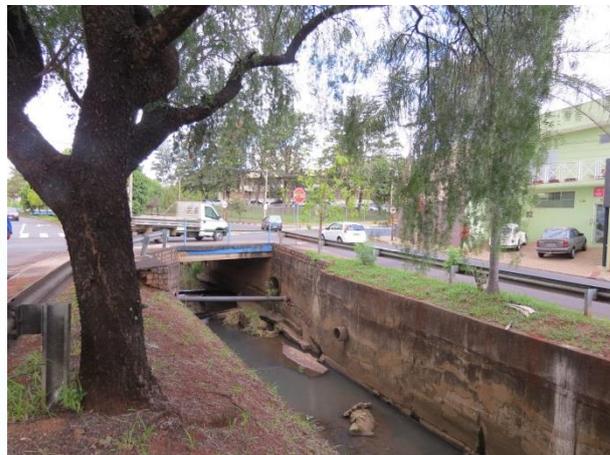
Vista de travessia do córrego Gregório, em trecho afetado por inundações. Notar dimensões do canal e do vão sob a ponte.
